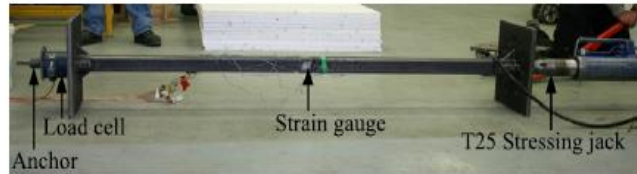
Pretensado del cable no adherido en viga tubular laminada en frío de 60 x 60 x 4 mm.
